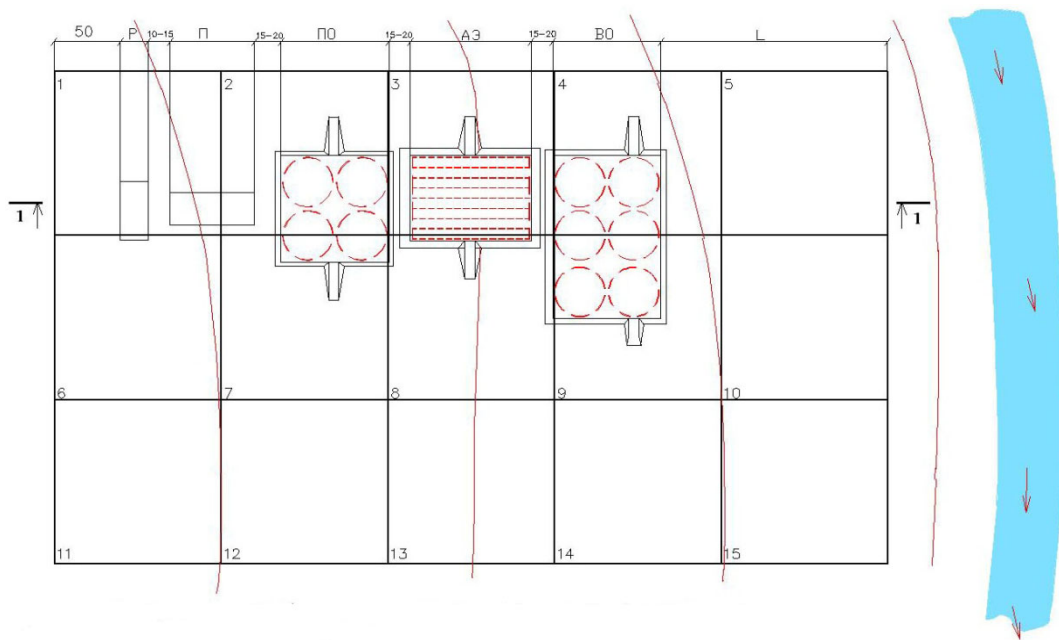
Ситуационный план площадки очистных сооружений водоотведения.
